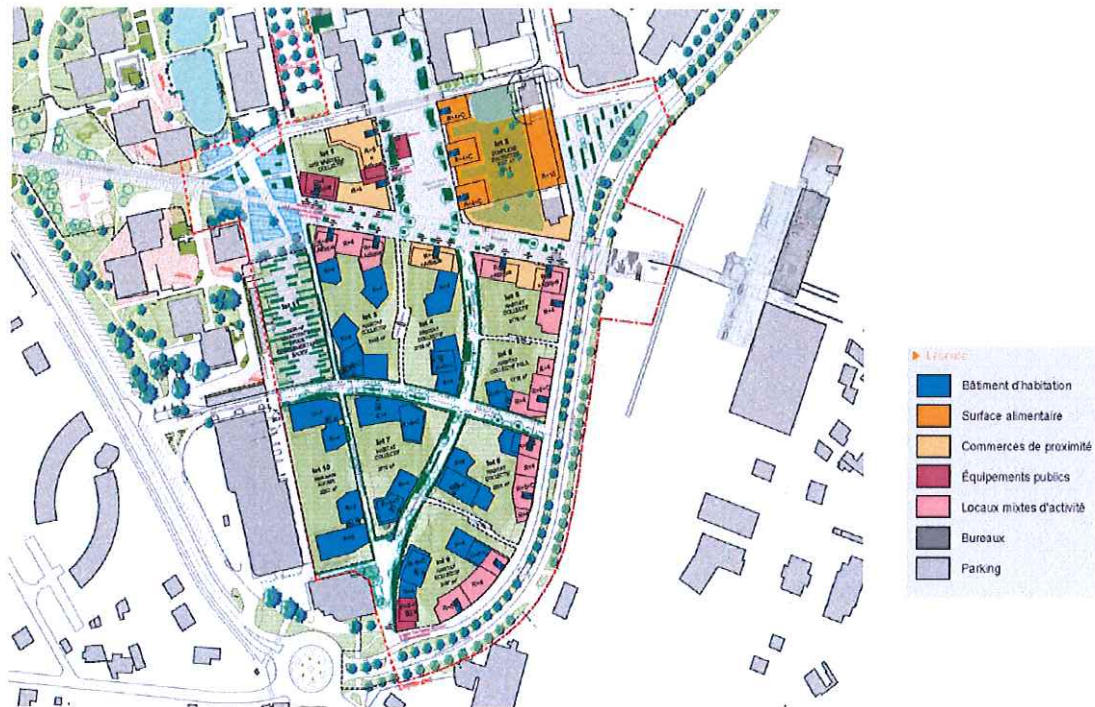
Plan d'aménagement de la ZAC (source : étude d'impact, p.106)
